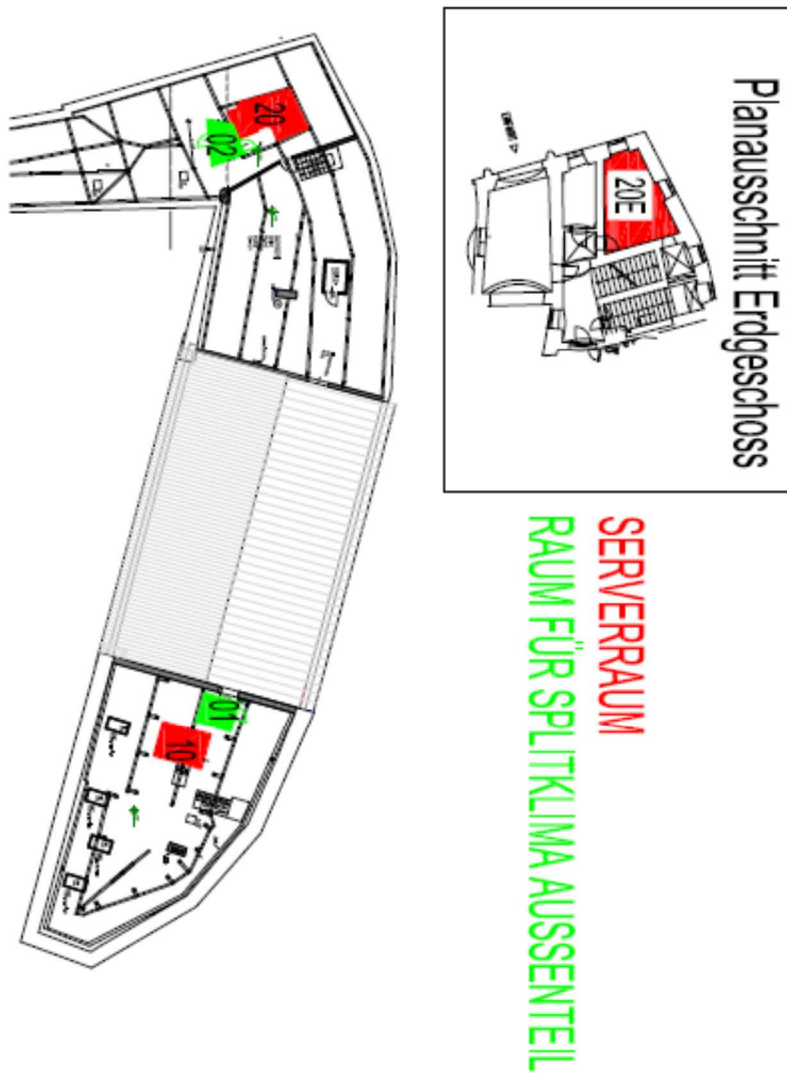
Übersicht Dachraum und Planausschnitt Erdgeschoss
